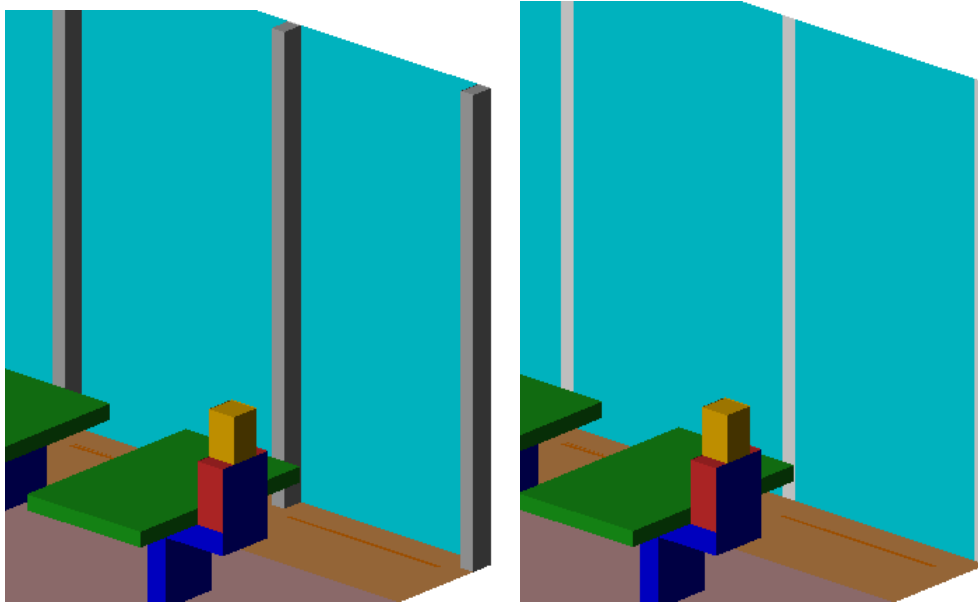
Detail Fassade: Links mit quaderförmigem Rahmen in den Raum hinein, rechts flacher Rahmen.
